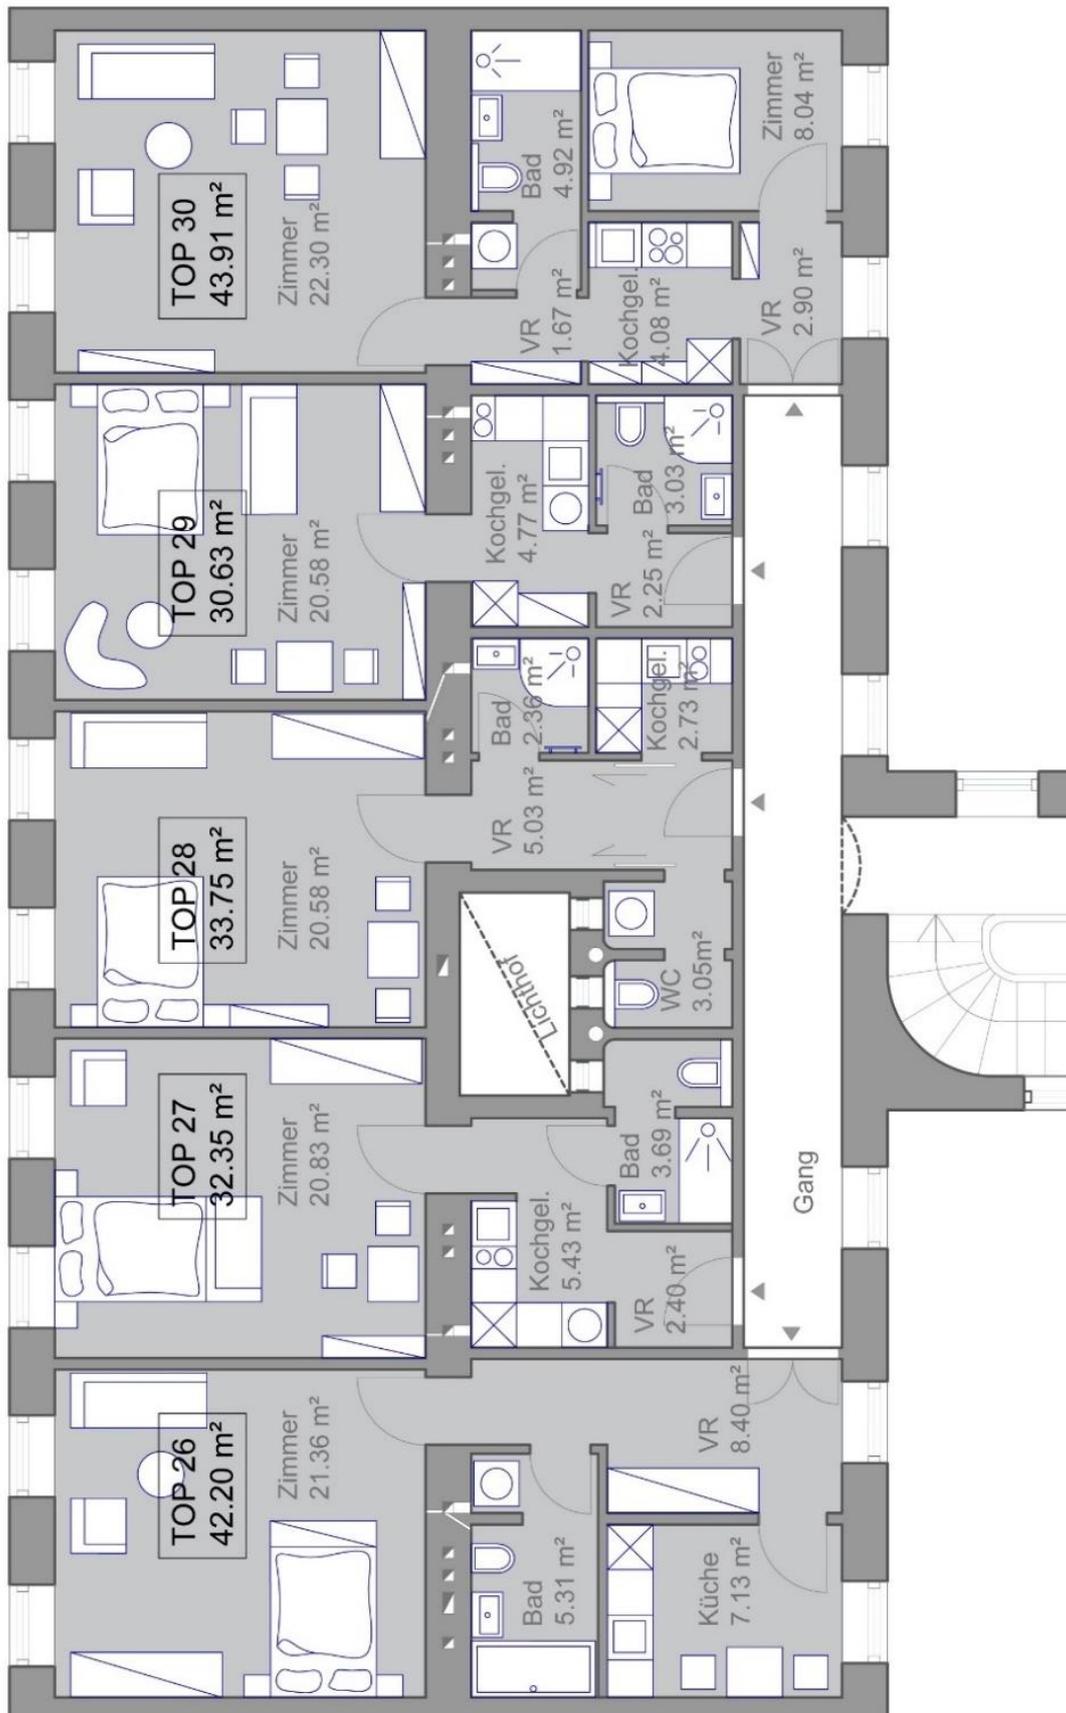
Variante 2, Grundrisse: Top 26, Top 27, Top 28, Top 29, Top 30
